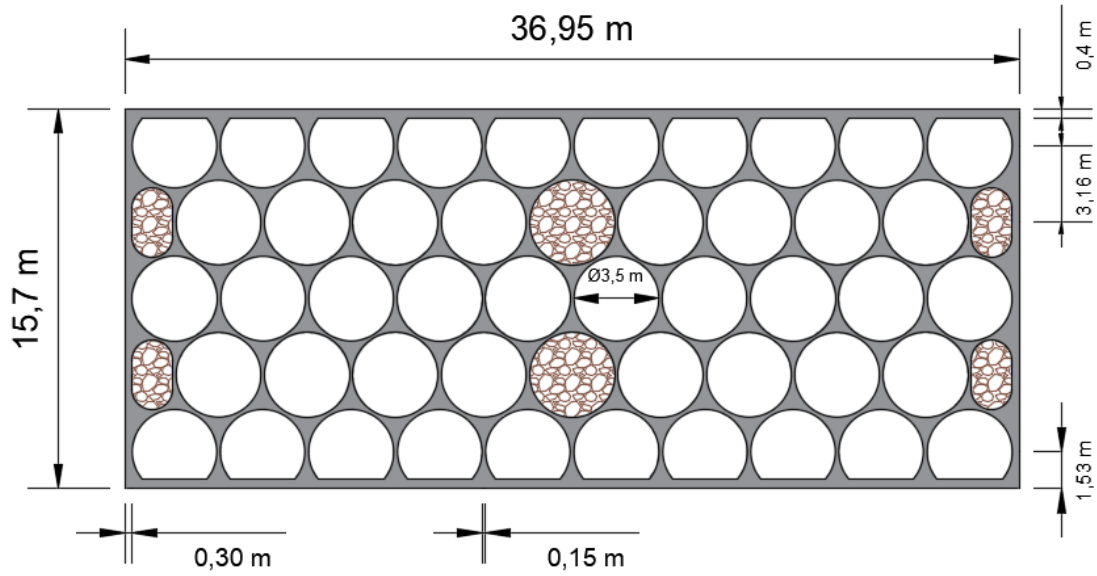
Geometría del cajón antirreflejante en planta. Fuente: Propia
